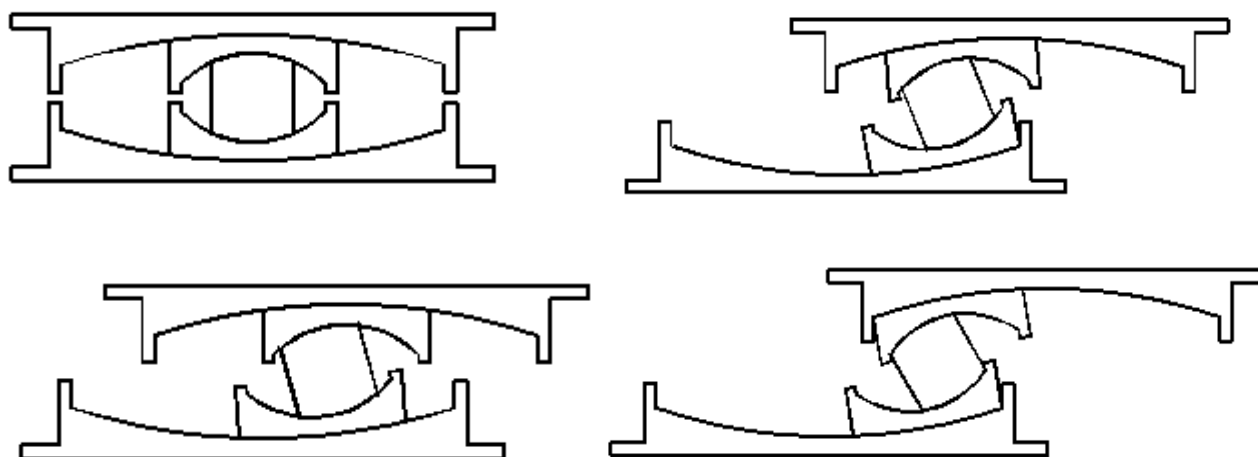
Общий вид и схема поведения трехмаятниковой опоры:
